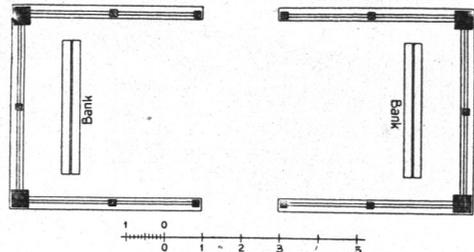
Rixbütteler Schutzhalle in Cuxhaven, Schutzhalle, Grundriß.
